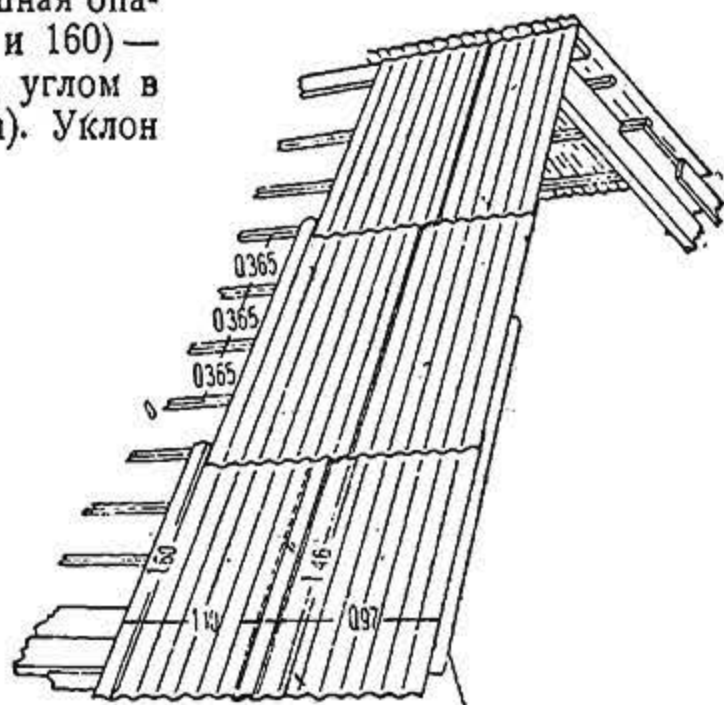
Покрытие кровли асбестшифером (одинарное немецкое покрытие).
